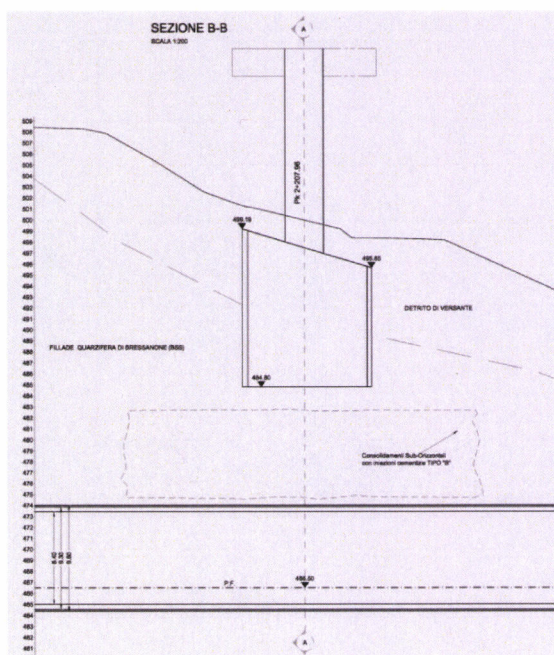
Sezione longitudinale – Intervento tipo B sotto la fondazione della pila 13
